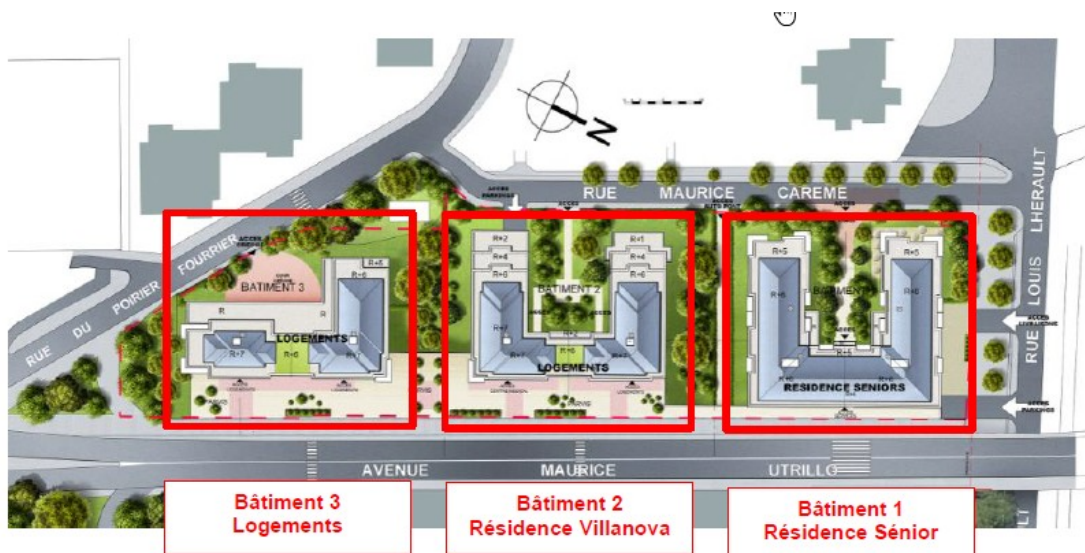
Plan masse du projet (accès crèche par le bâtiment 3) - source : étude d'impact
